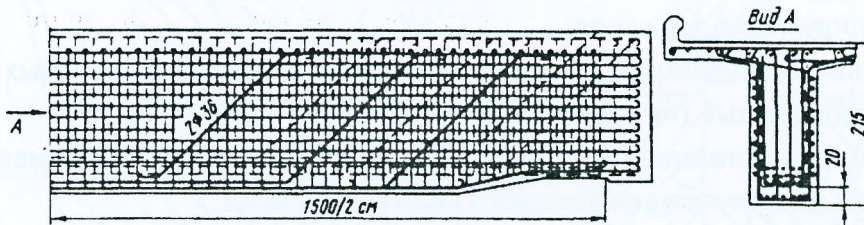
Усиление пролетного строения железобетонной оболочкой (на фасаде балки показана только арматура усиления).
